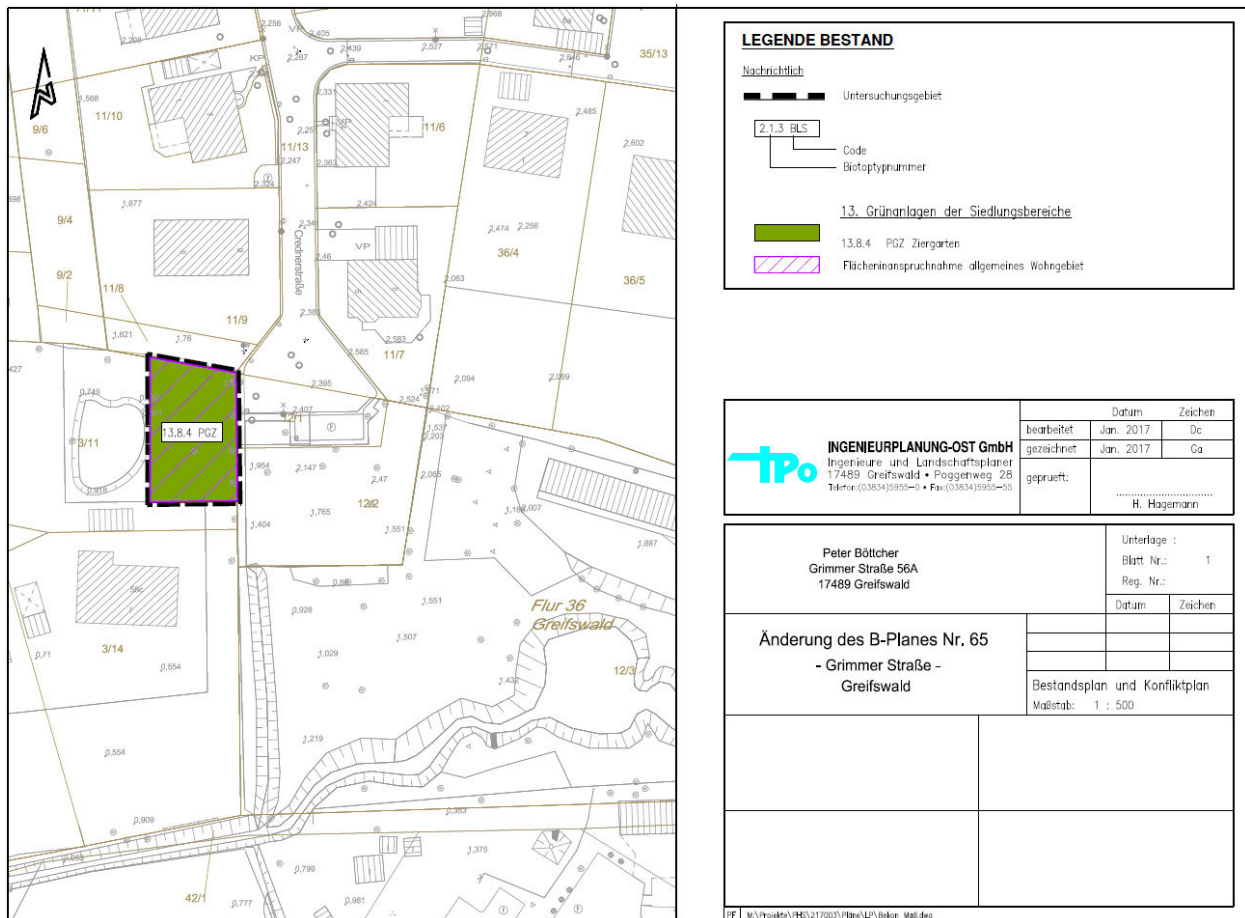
Planänderungsbereich des B-Planes 65 (ohne Maßstab)
